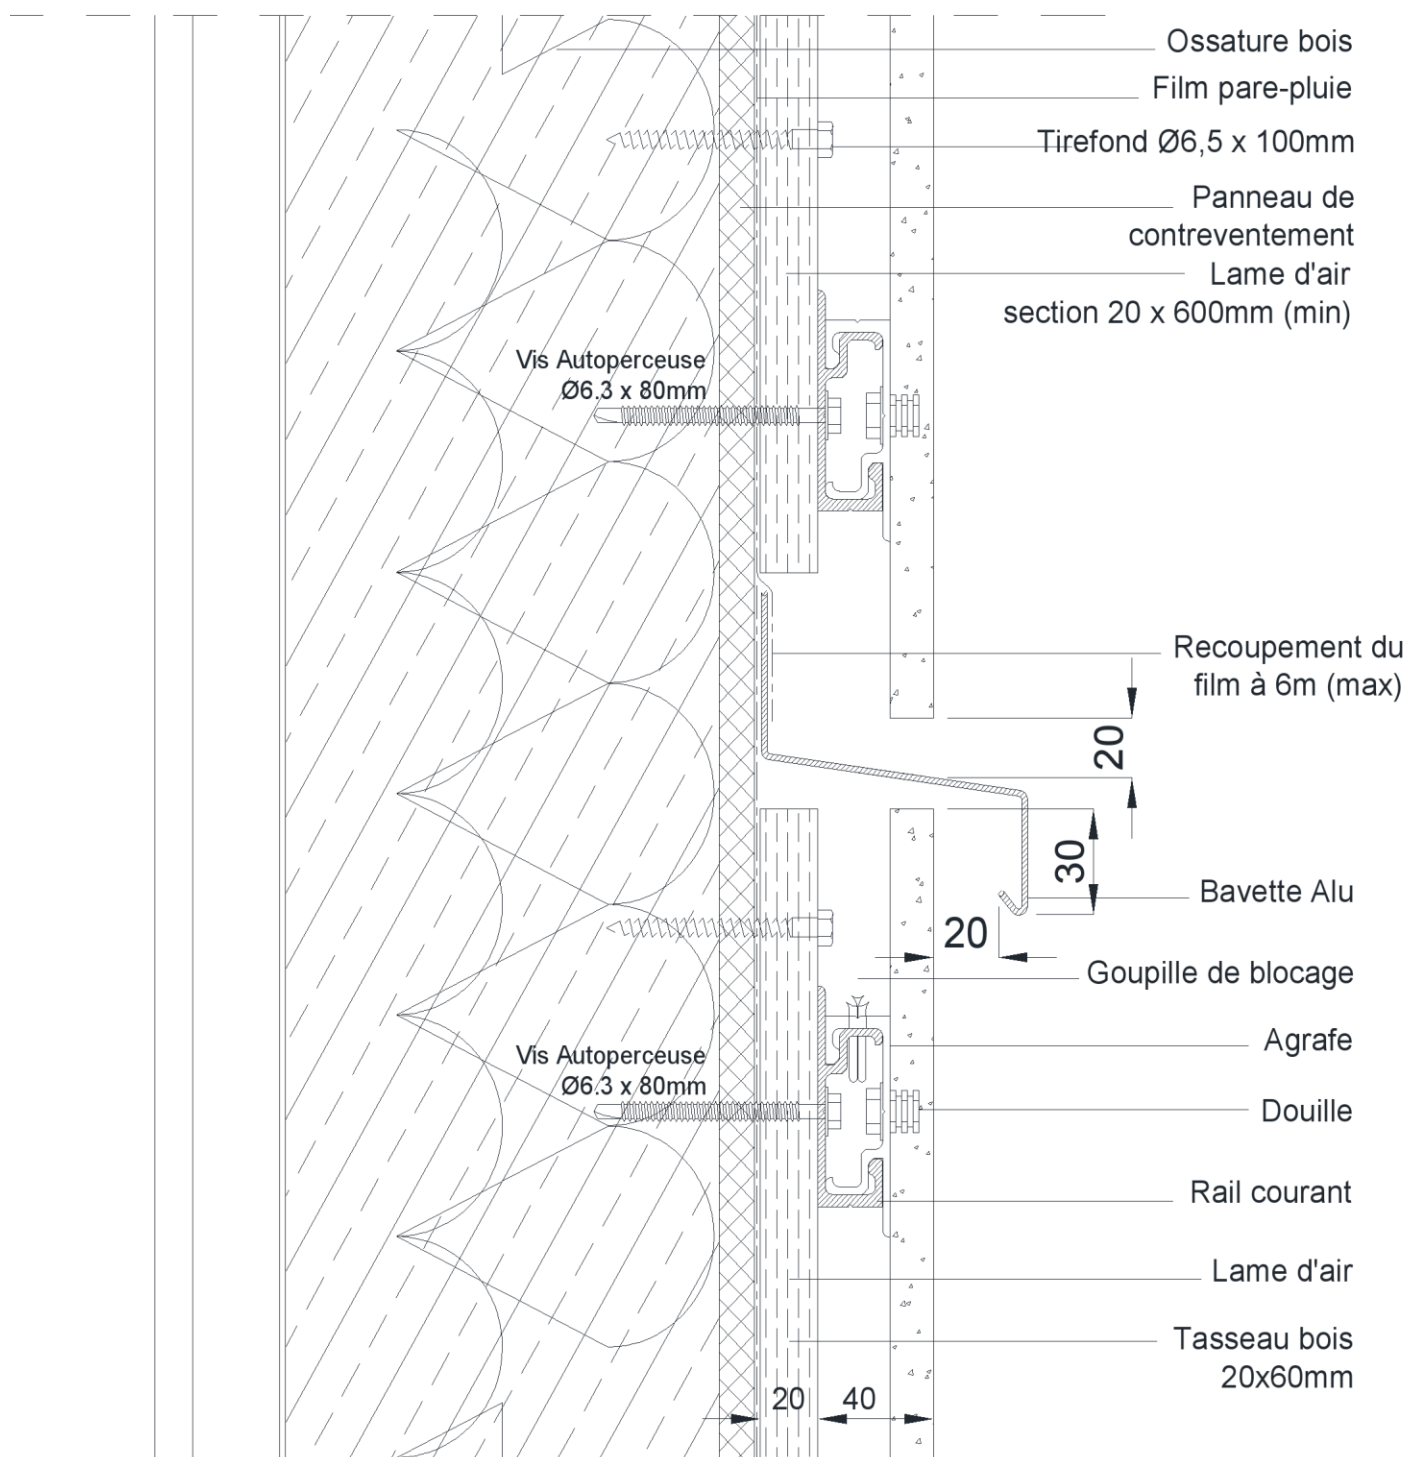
Coupe verticale - Recoupement du pare pluie tous les 6 m
